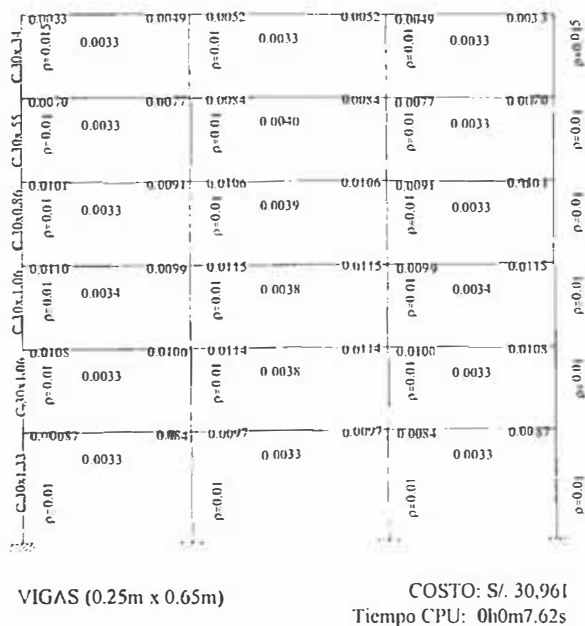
Solución óptima con vigas de dimensión preestablecida y columnas de igual dimensión por piso.
